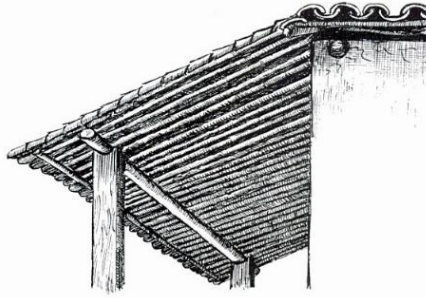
Detalle de cubierta. Techo de teja con en una estructura de varillas de calzonte.<sup>210</sup>
